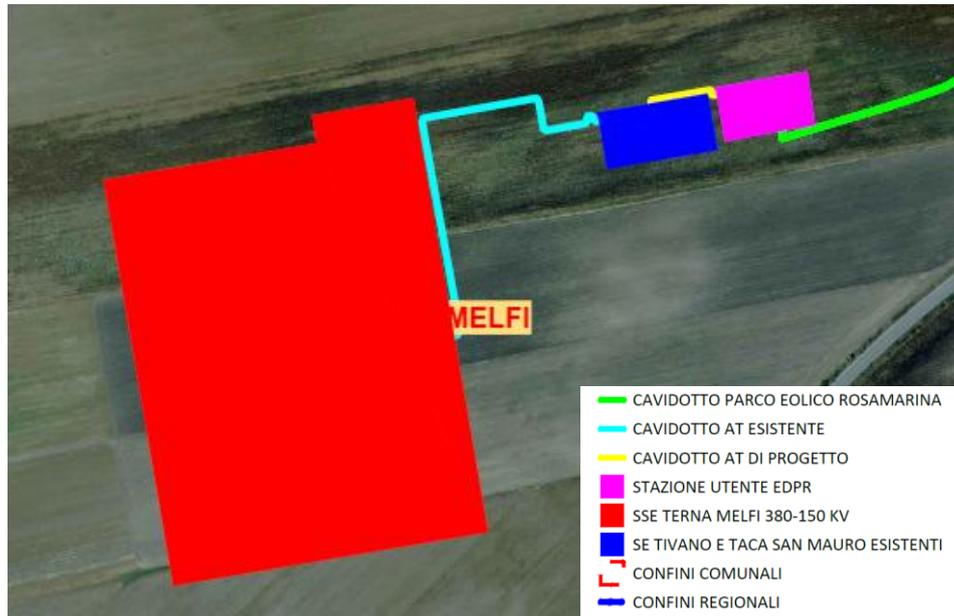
Stralcio planimetrico area sottostazione nel territorio comunale di Melfi
